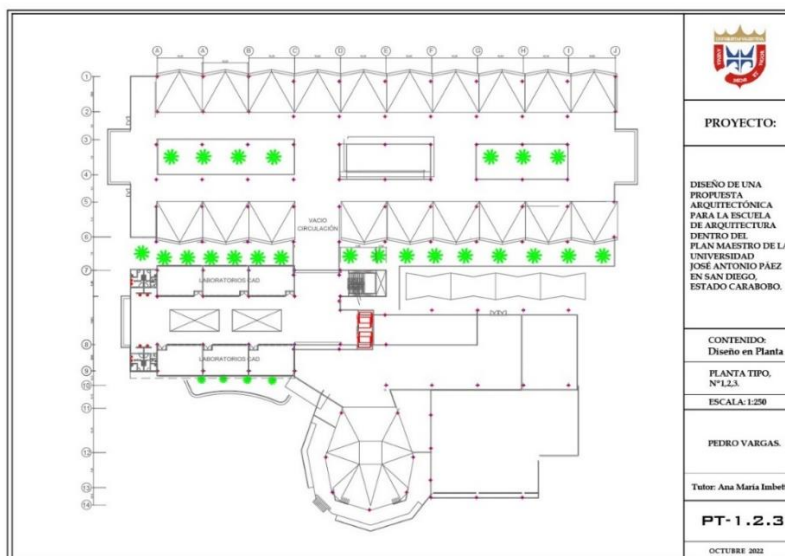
Plano de diseño en vista de planta para los pisos tipo 1,2,3.
